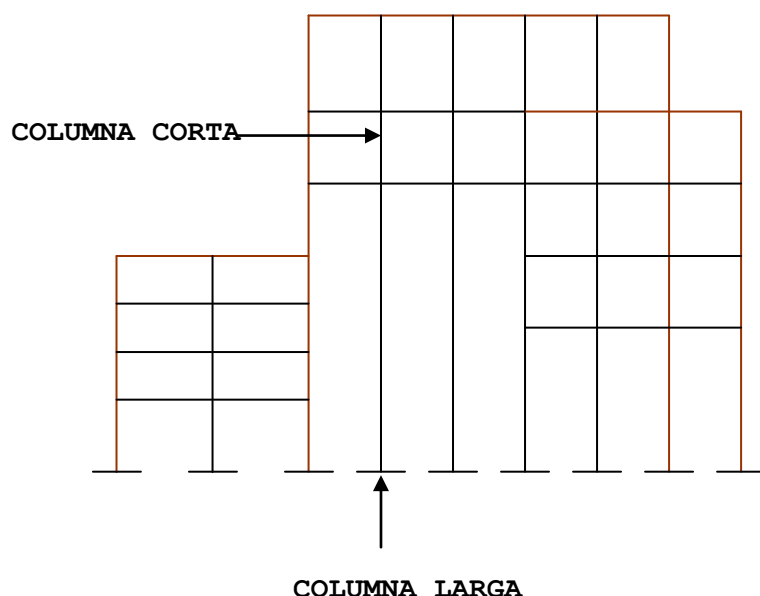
APARECIMIENTO DE COLUMNAS CORTAS
